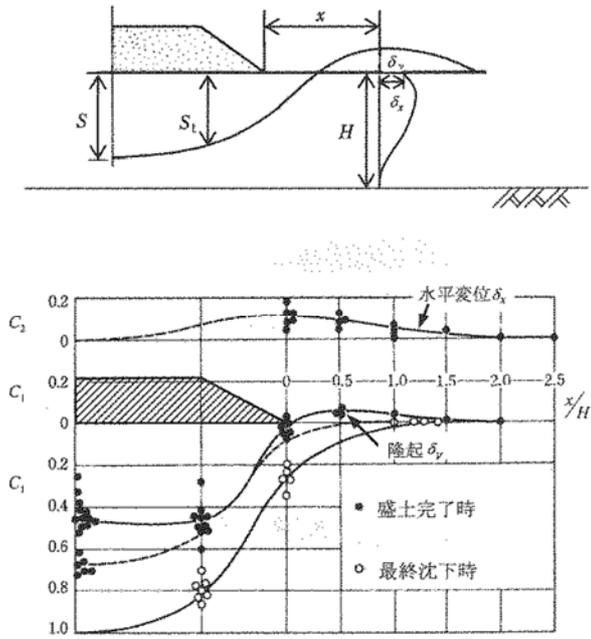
盛土の沈下形状と側方への影響 (高速道路、一般国道)
